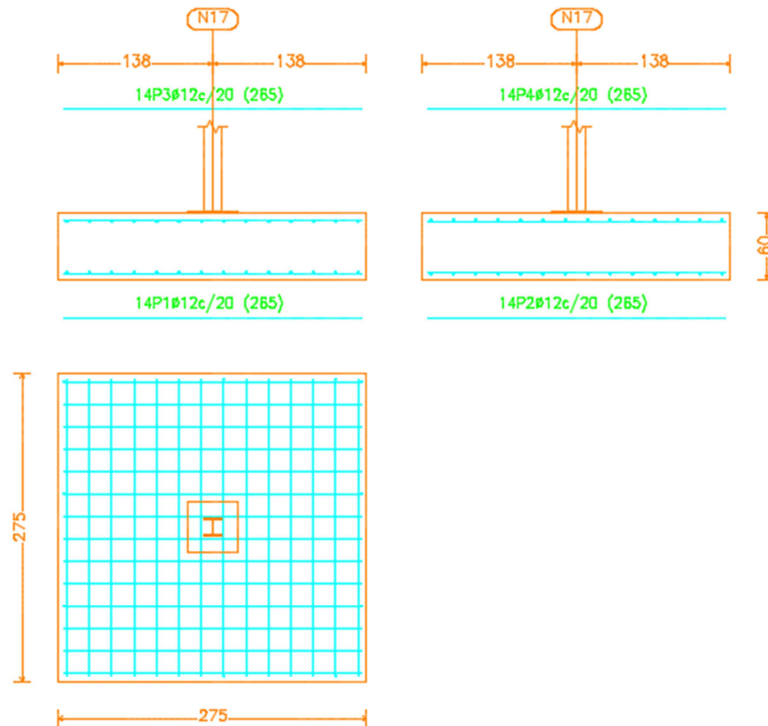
Detalle de la cimentación de los pilares de pórticos intermedios
